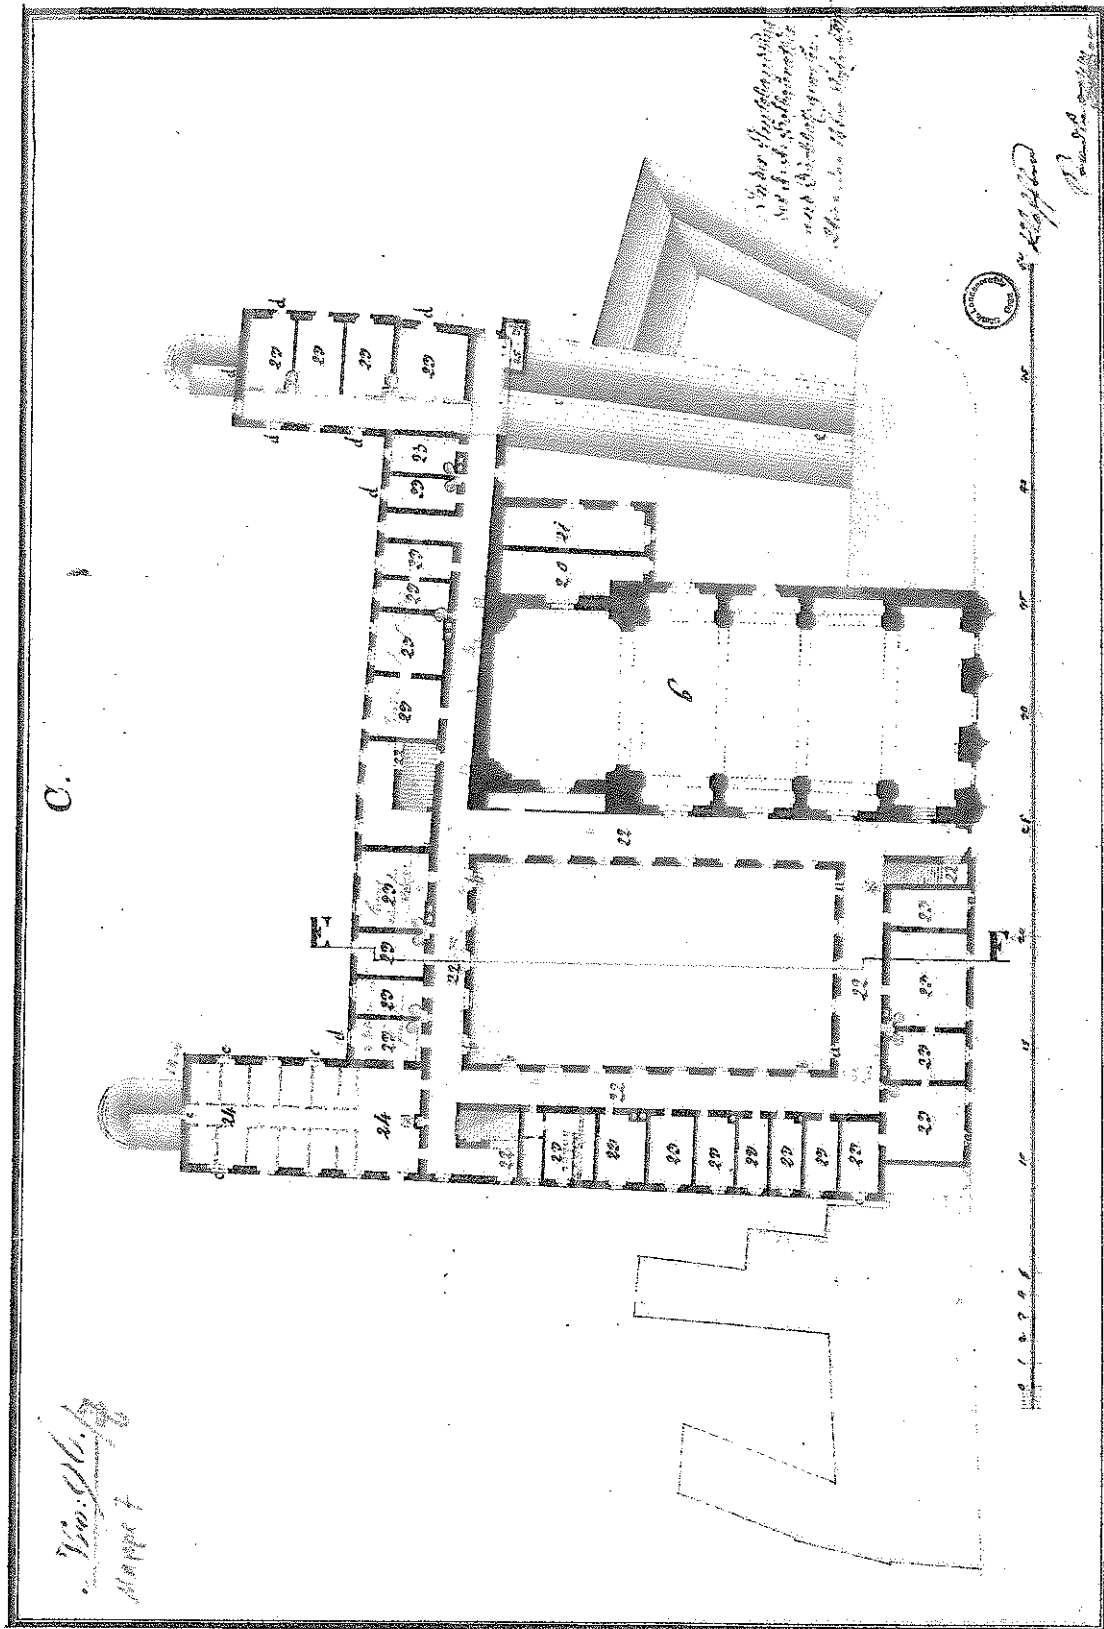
Christoph Stadler, Kloster und Spital der Barmherzigen Brüder mit Barmherzigenkirche, Zeichnung, um 1811, Grundriss 2. Obergeschoss.
